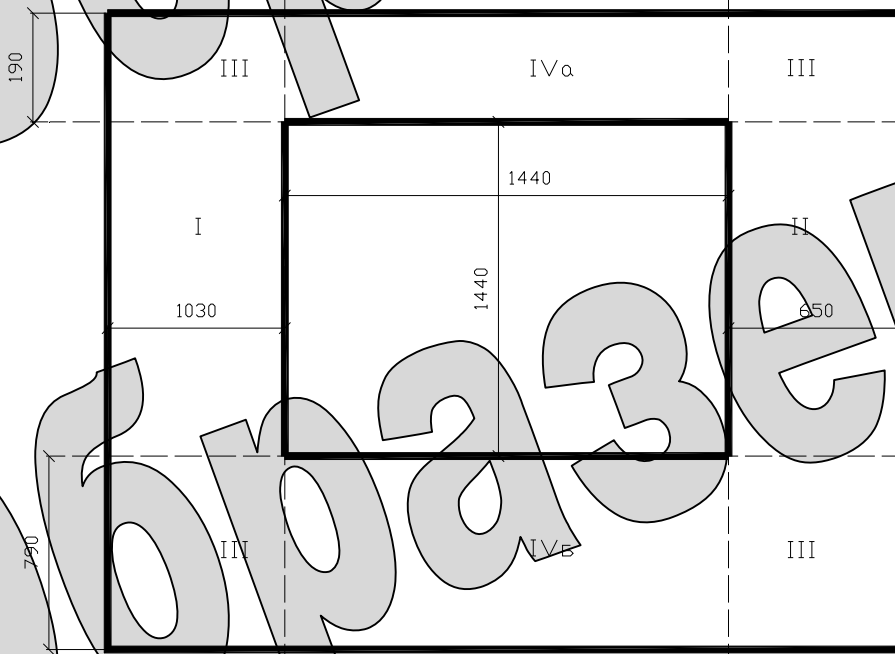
Расчетная схема фрагмента наружной стены
